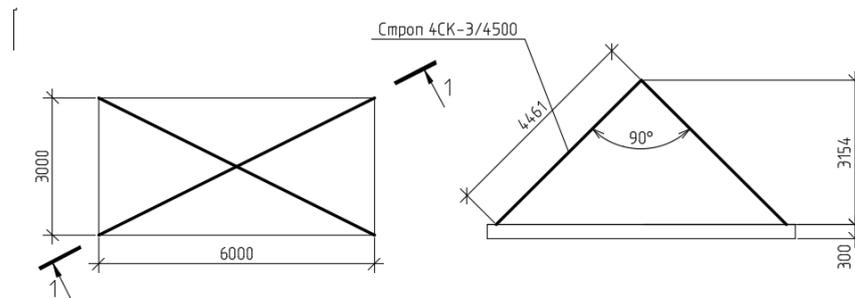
Определение длины стропов при монтаже плит покрытия.
